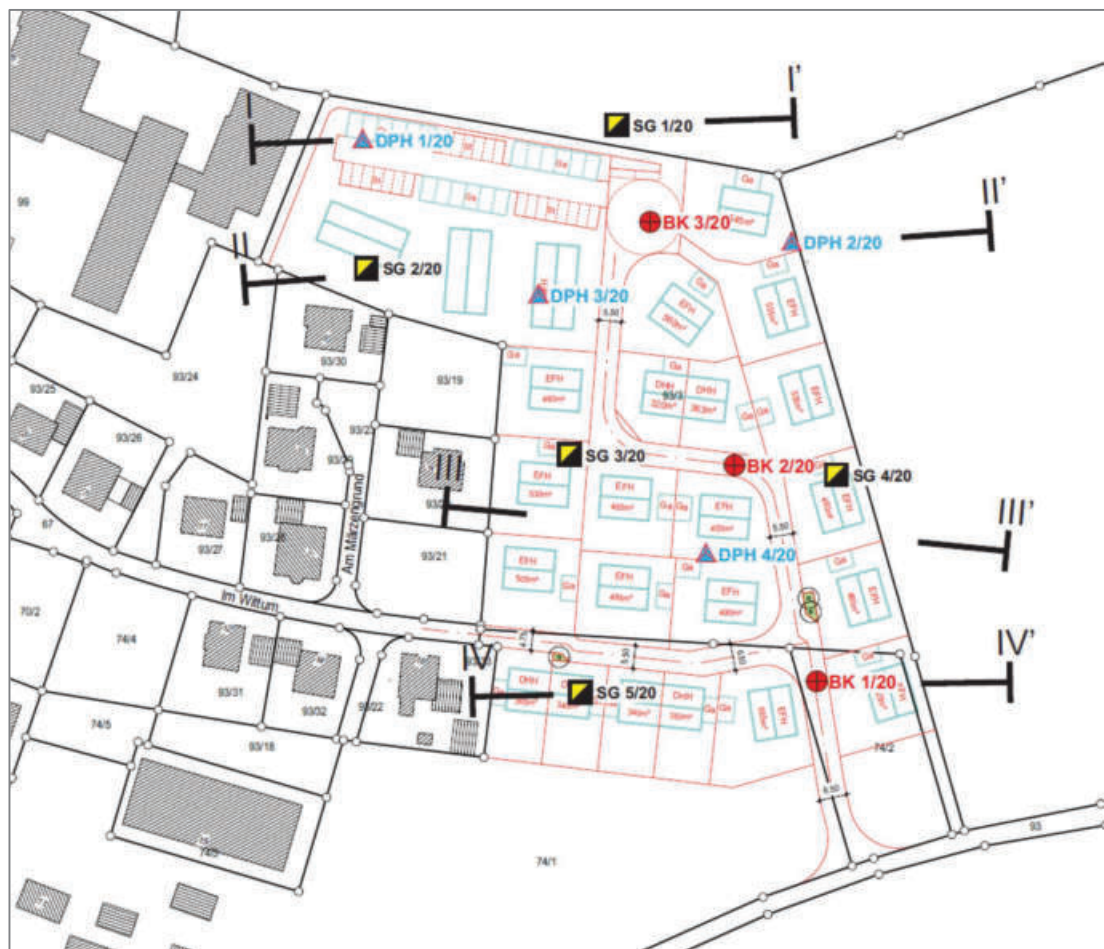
Lage der Geotechnischen Aufschlüsse (Plangrundlage: Bebauungsplan Variante B, Stadt Leutkirch)
